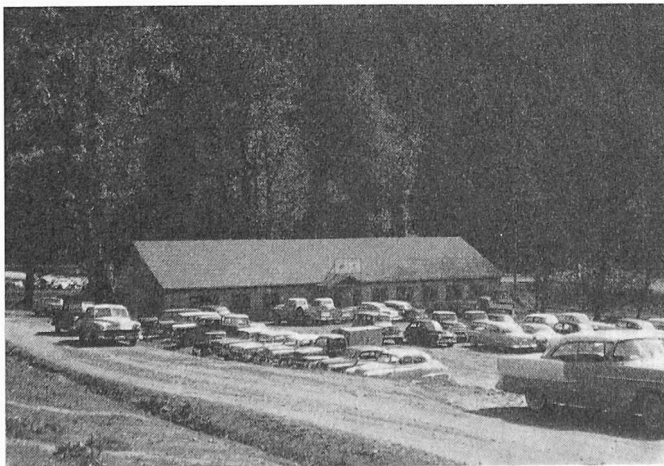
Swift-Damm, Baubureau mit Parkplatz für Personal
